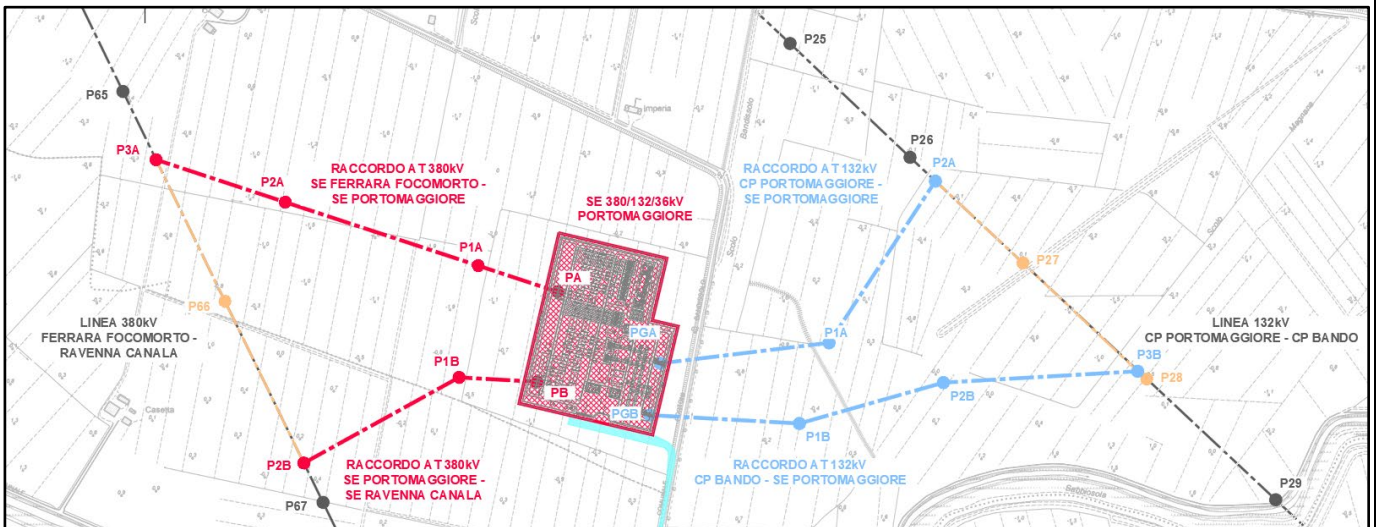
stralcio della planimetria con indicazione delle opere in progetto
